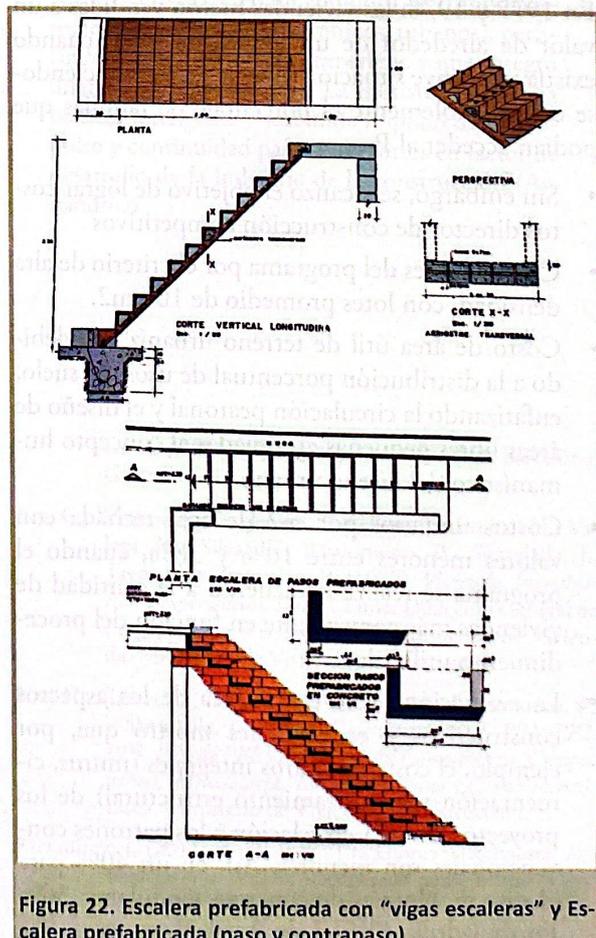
Escalera prefabricada con "vigas escaleras" y escalera prefabricada (paso y contrapaso)
